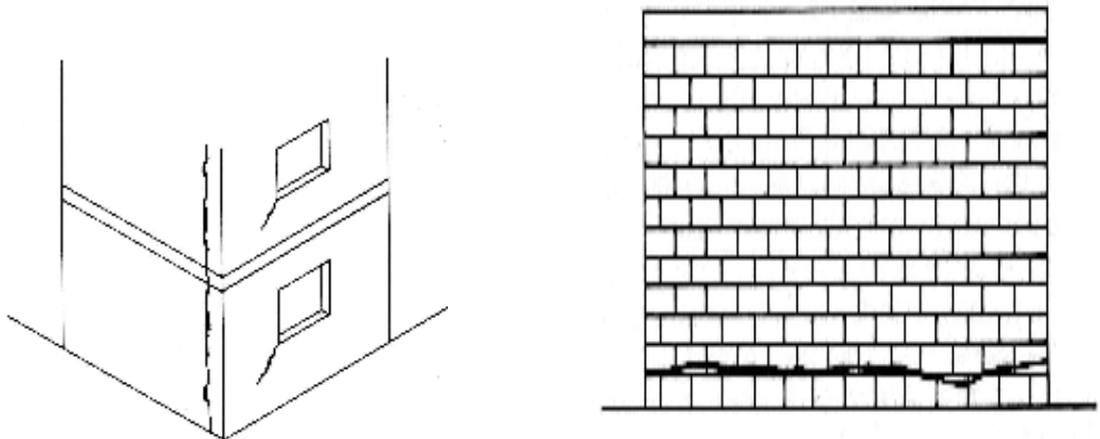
Fissuração vertical da alvenaria no canto da obra e fissura horizontal na base de alvenaria provocada por movimentação higroscópica.
